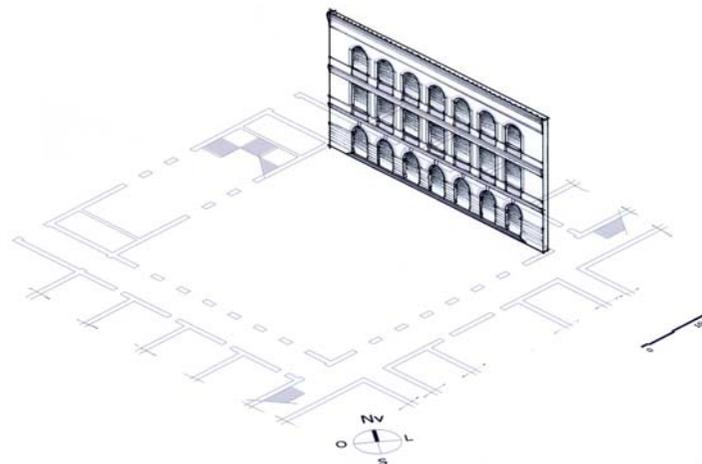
Estudo dos planos verticais, fachada Nordeste do pátio interno do ISE RJ.
